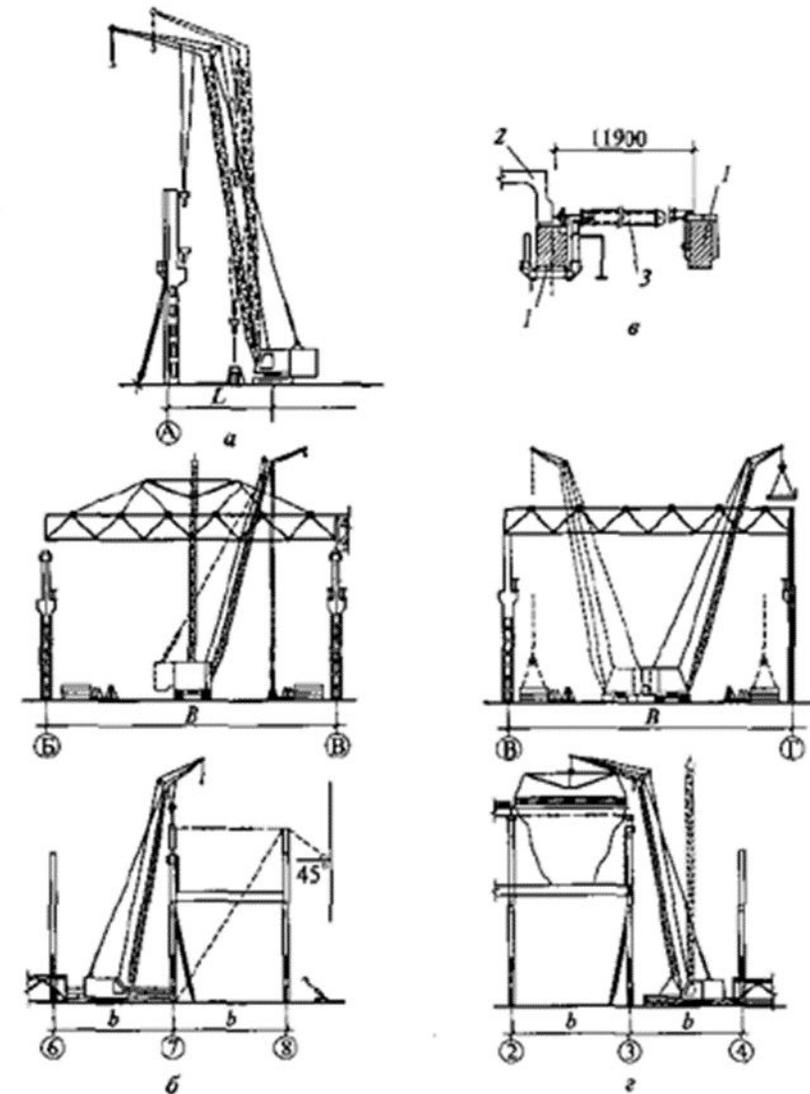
Схемы монтажа и временного крепления сборных элементов: а — подкрановой балки; б, в — фермы и плиты покрытия; а — узлы крепления распорки; 1 — ферма; 2 — плита покрытия; 3 — распорка
